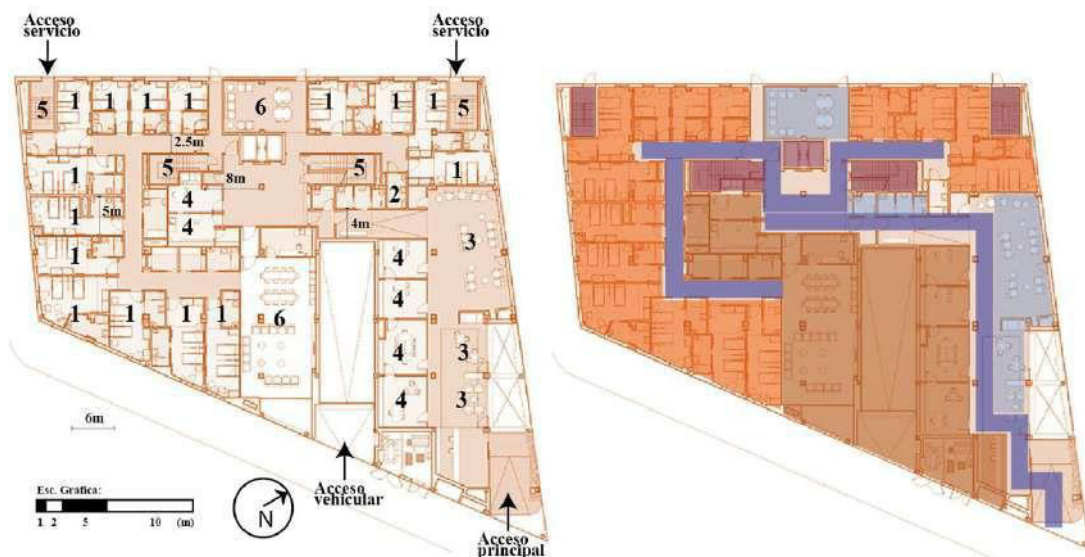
Planta baja. Fuente: Elaboración propia
